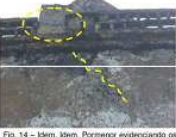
Idem. Idem. Pormenor evidenciando os elementos em falta na platibanda da cobertura e a fenda diagonal existente sob a mesma.
